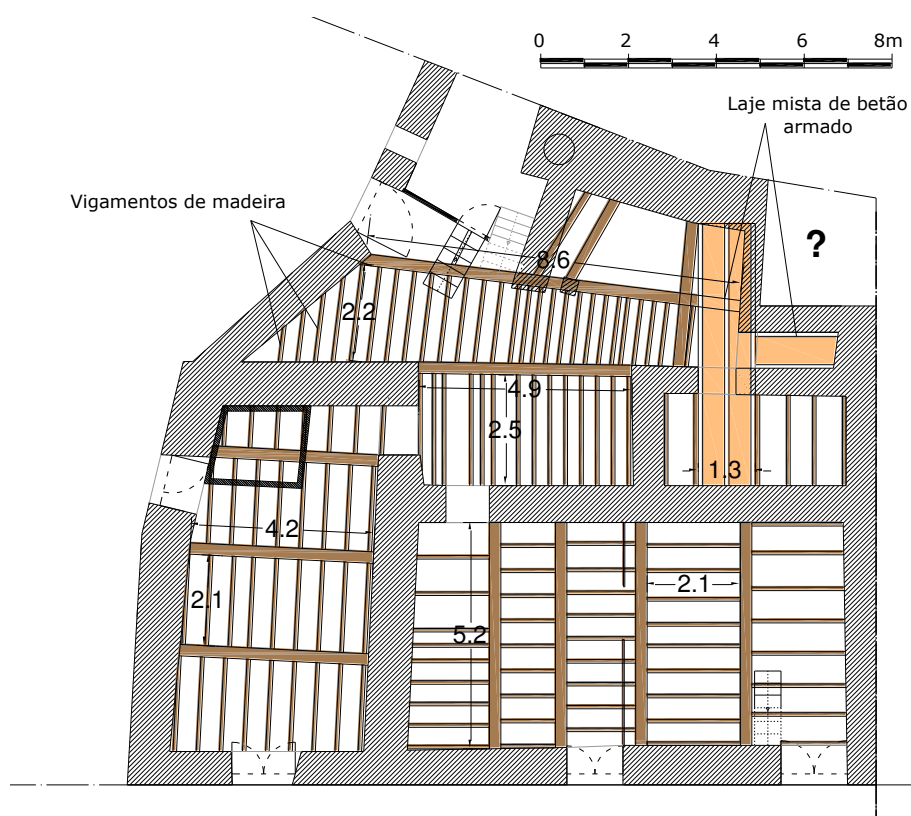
50 – Esquema representativo da distribuição de vigas de apoio do pavimento.
